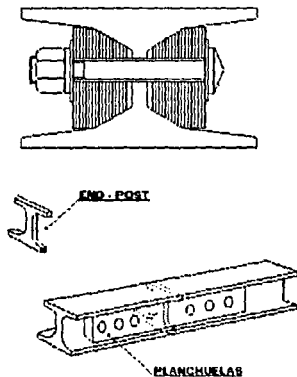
JUNTA AISLANTE PARA PISTA METÁLICA
